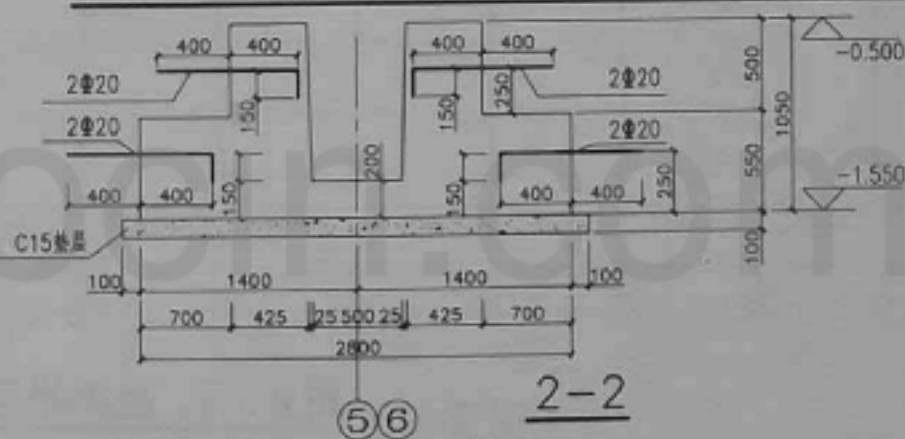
J-1a、J-1b拉结筋位置(未示其他钢筋)
